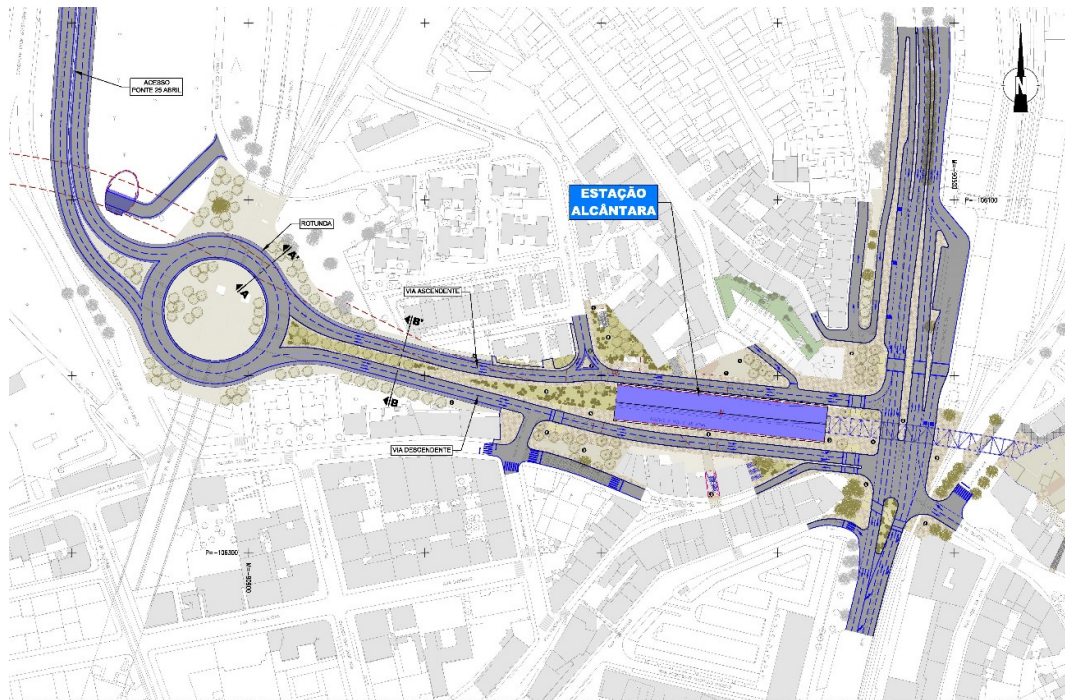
Estação Alcântara – Planta Geral de Implantação
